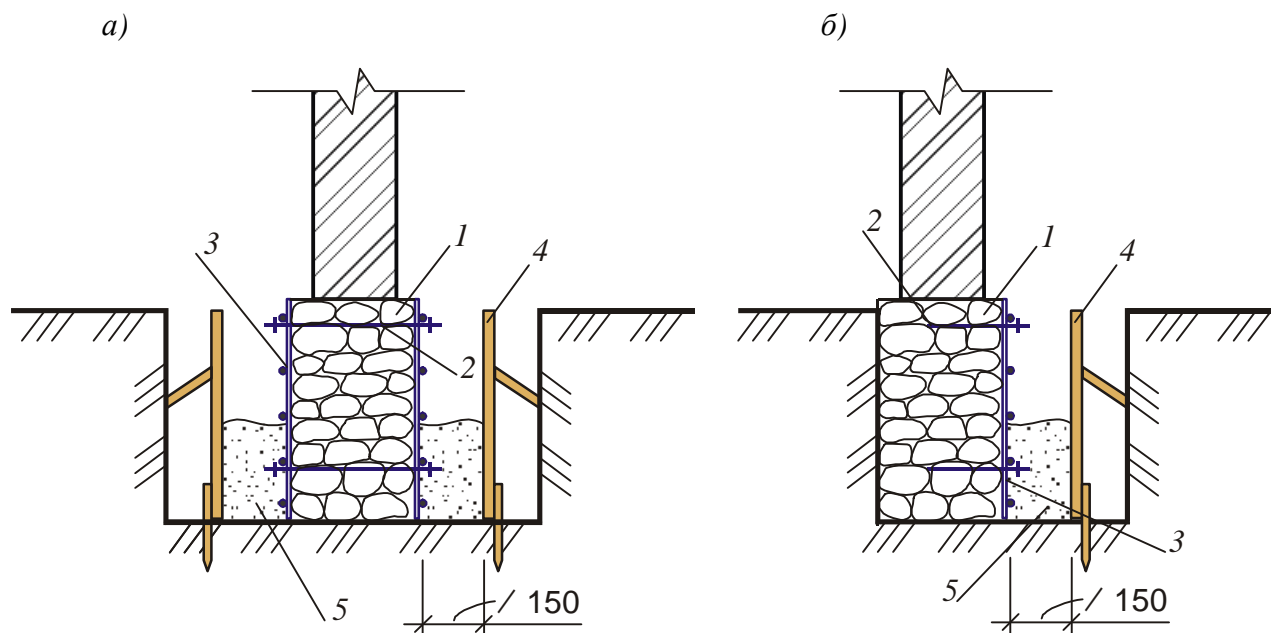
Усиление бутовых фундаментов путем устройства железобетонной обоймы: а – двухсторонней; б – односторонней; 1 – бутовый фундамент; 2 – анкер; 3 – арматурная сетка; 4 – опалубка; 5 – бетонная смесь
